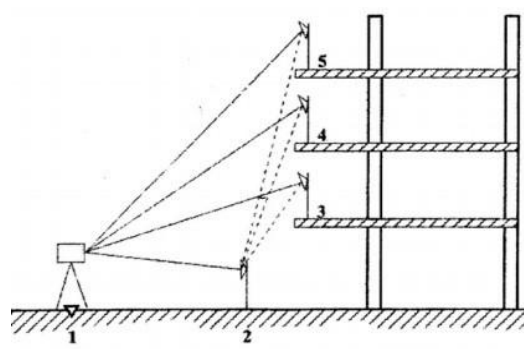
Передача осей и отметок на верхние этажи здания
